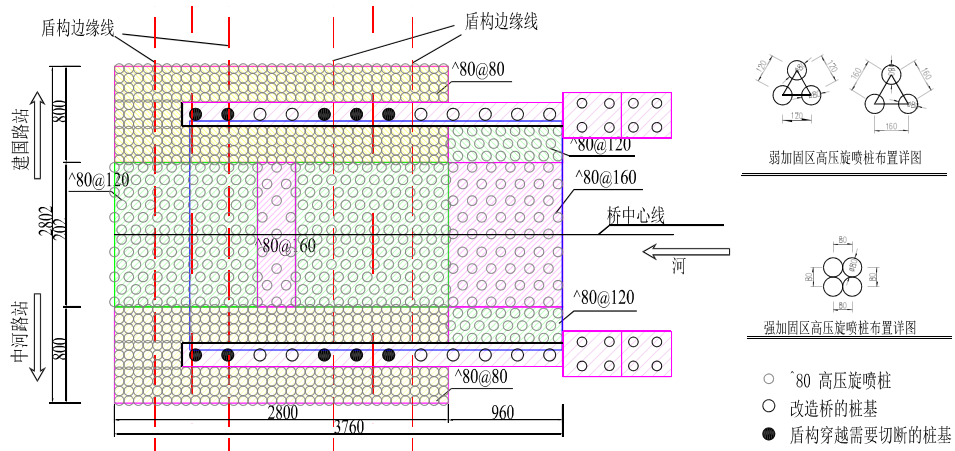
盾构隧道穿越桥梁桩基平面图 (加固后) (单位: cm)
